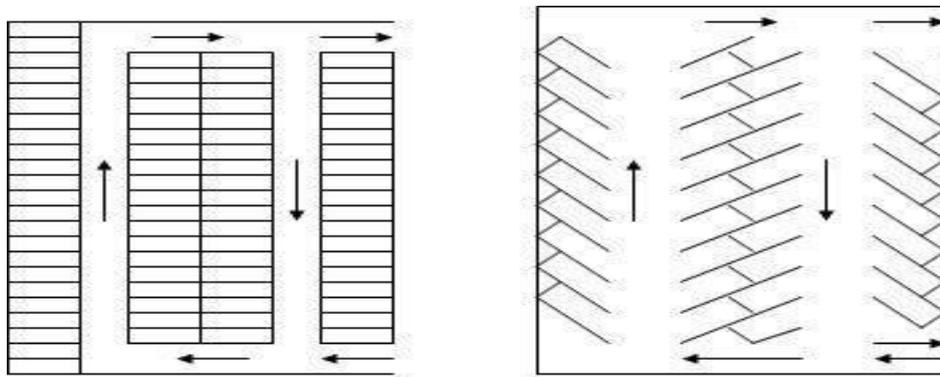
Parkir Sudut yang Saling Berhadapan
